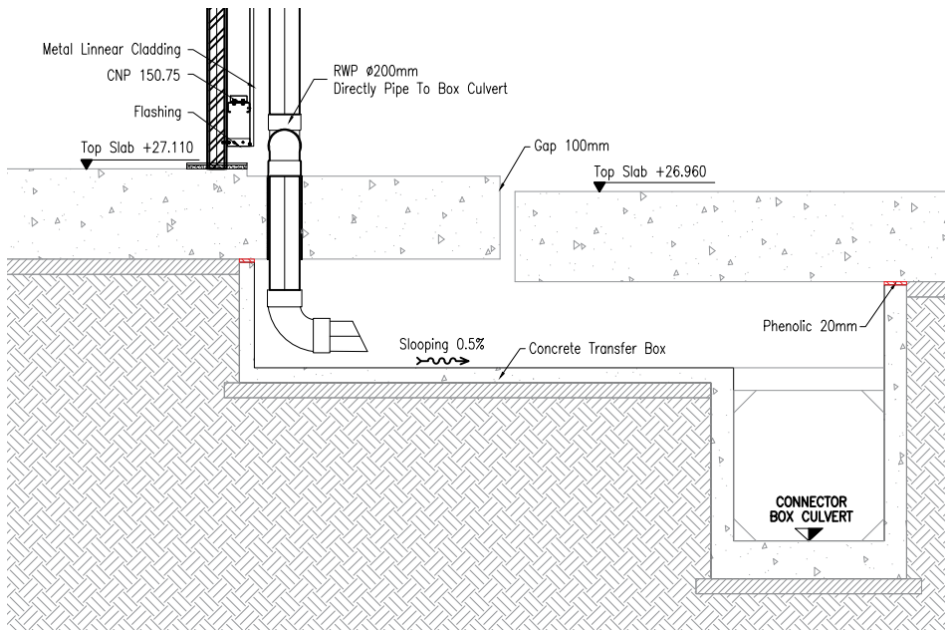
51 *Layout Drainase Heavy Maintenance
